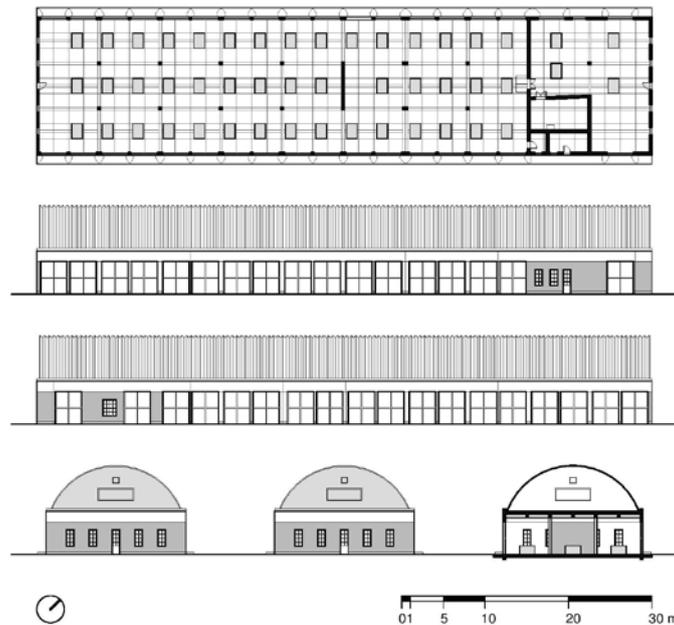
Rehabilitación del pabellón de artillería sur: planta principal, alzado sureste, alzado noroeste, alzado suroeste, alzado noreste y sección transversal de la construcción (Drawing by Pablo Llamazares Blanco).
